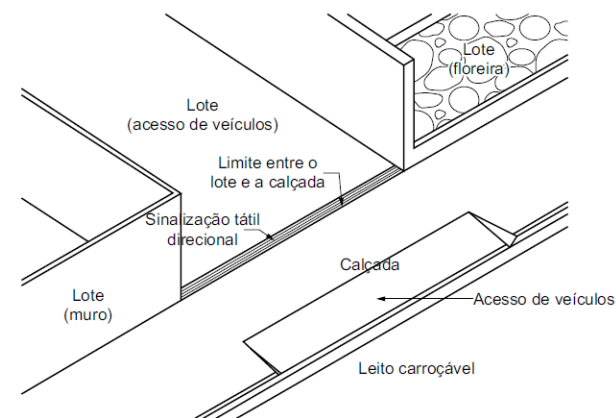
Alinhamento de lote não edificado, entre outros lotes edificados
